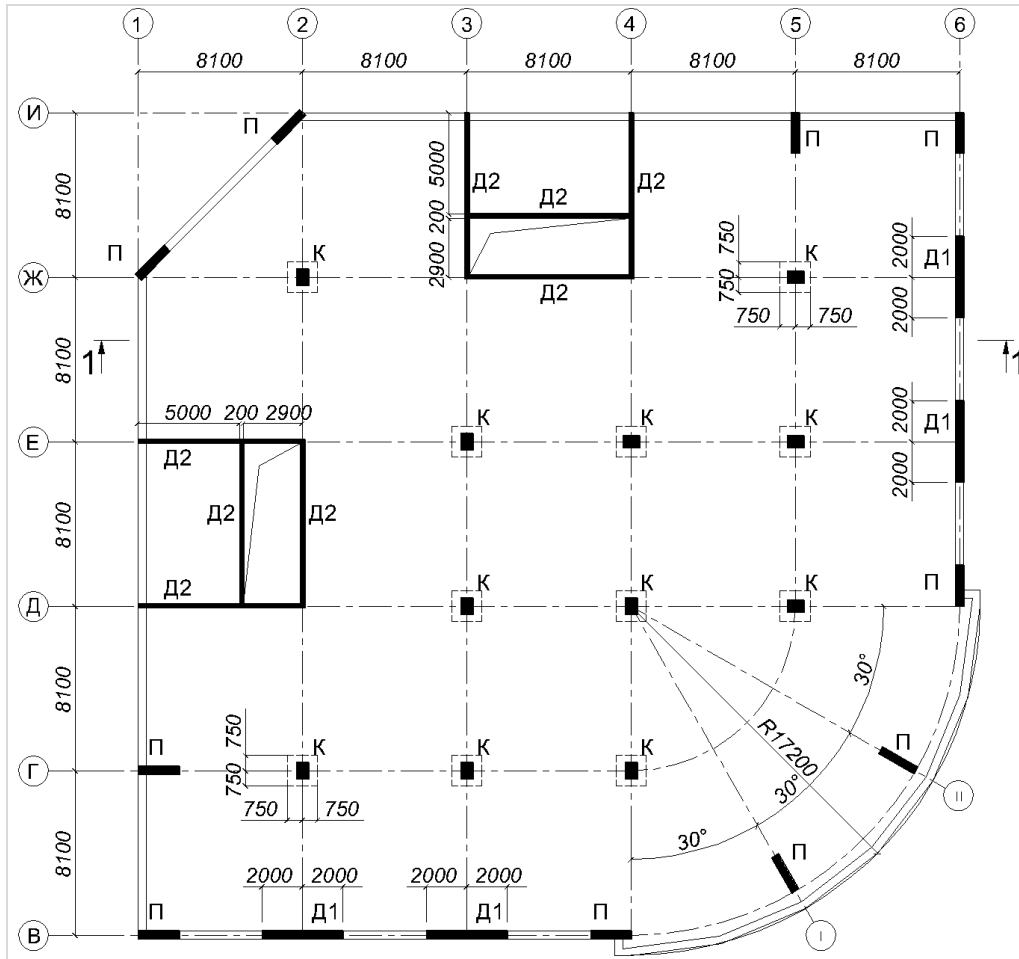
План типового этажа на отметках от 13.200м до 46.200м
